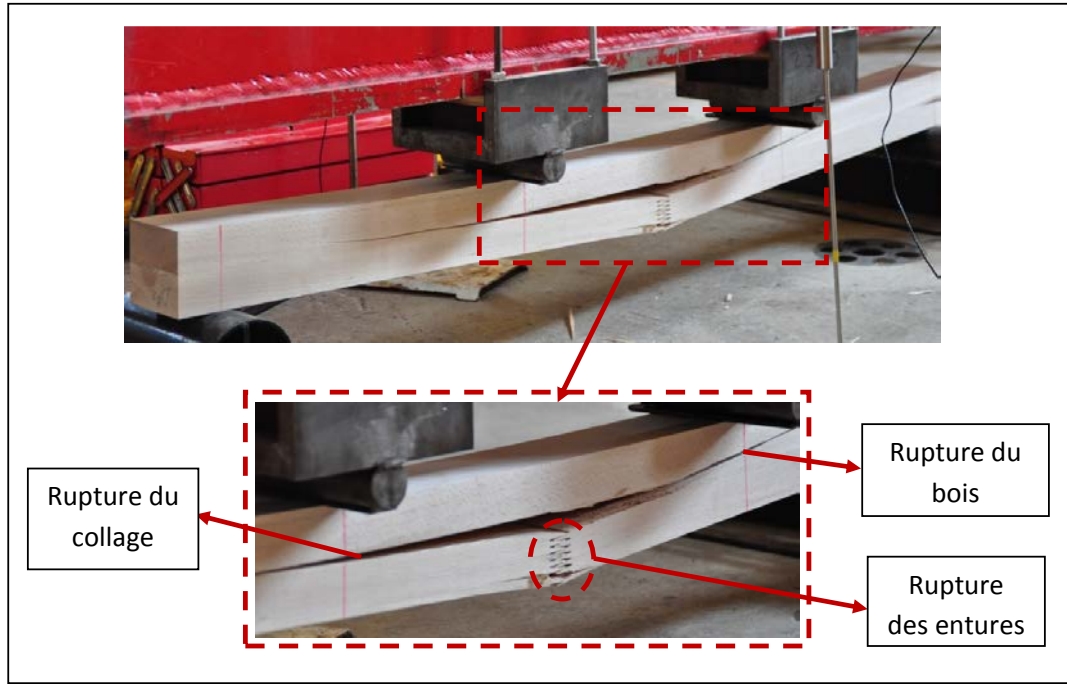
Mode de rupture typique des poutres DUO avec aboutage inférieur (type E).
